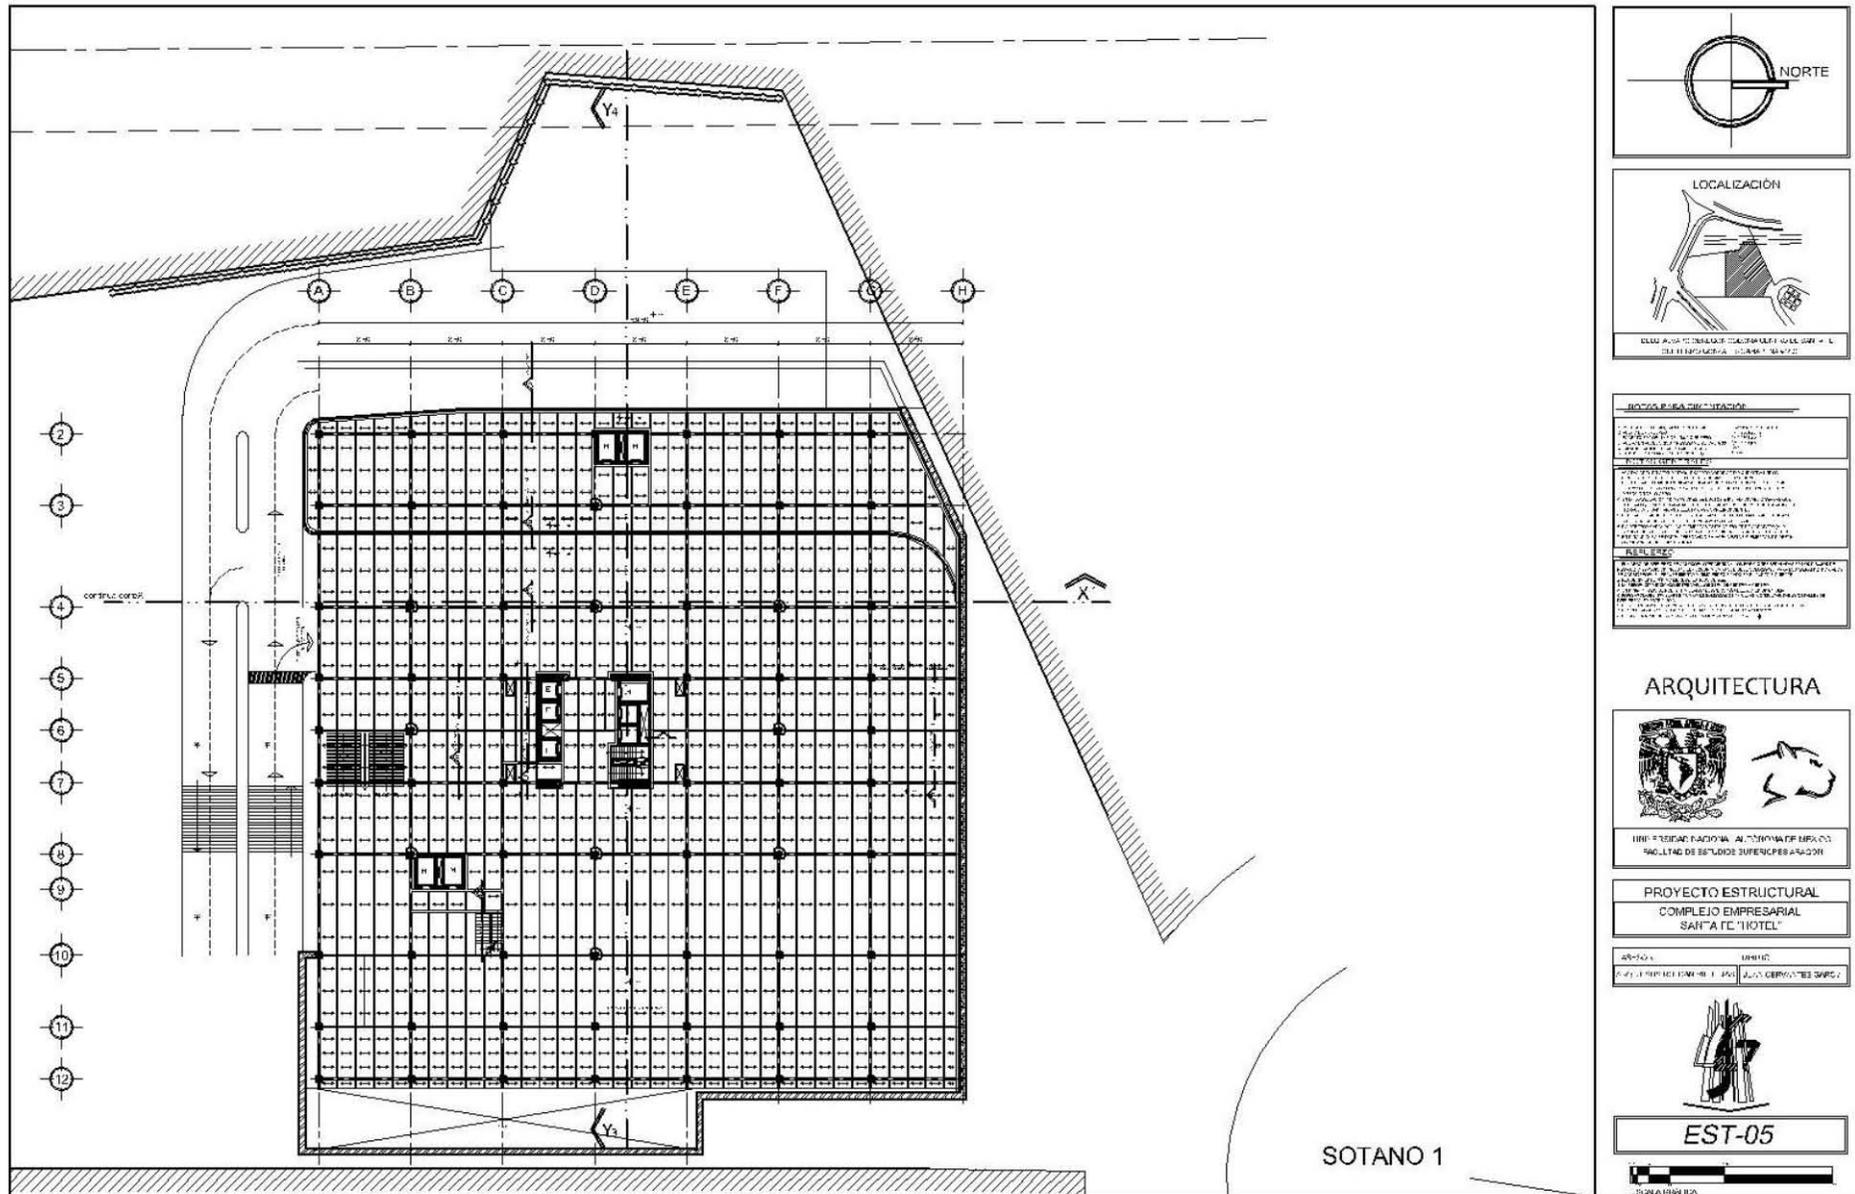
Plano Est-05; Colocación de losacero en sótano 1. Edición propia.
